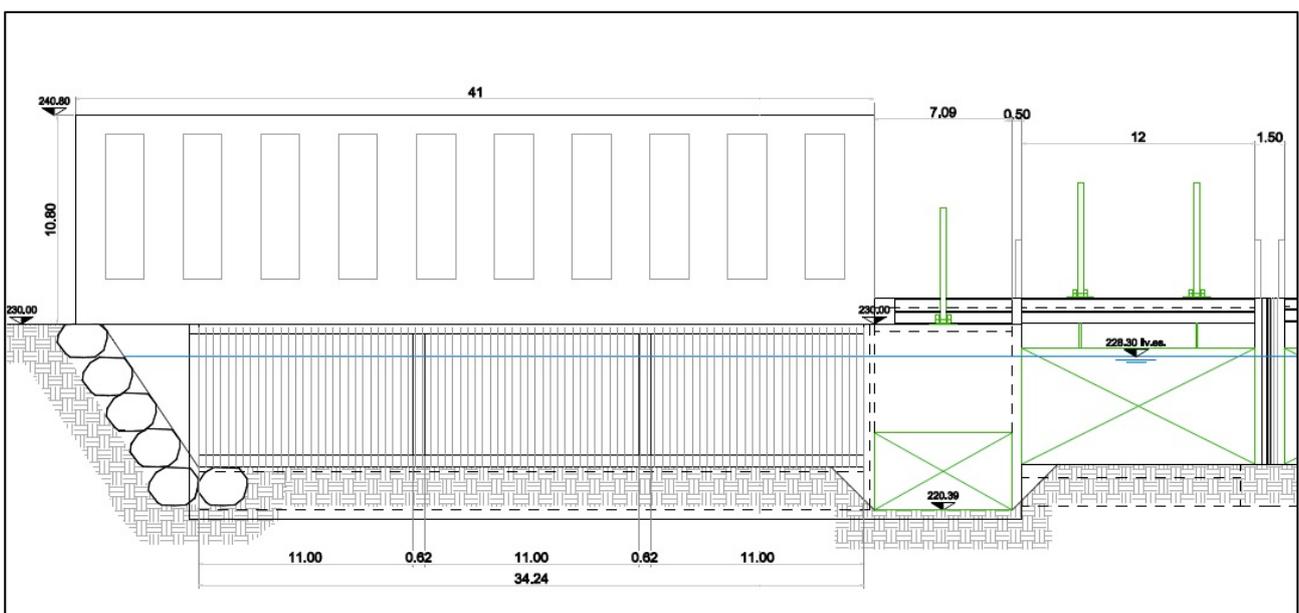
PROSPETTO FRONTALE SCHEMATICO DELL'EDIFICIO CENTRALE DI PRODUZIONE DI PROGETTO
